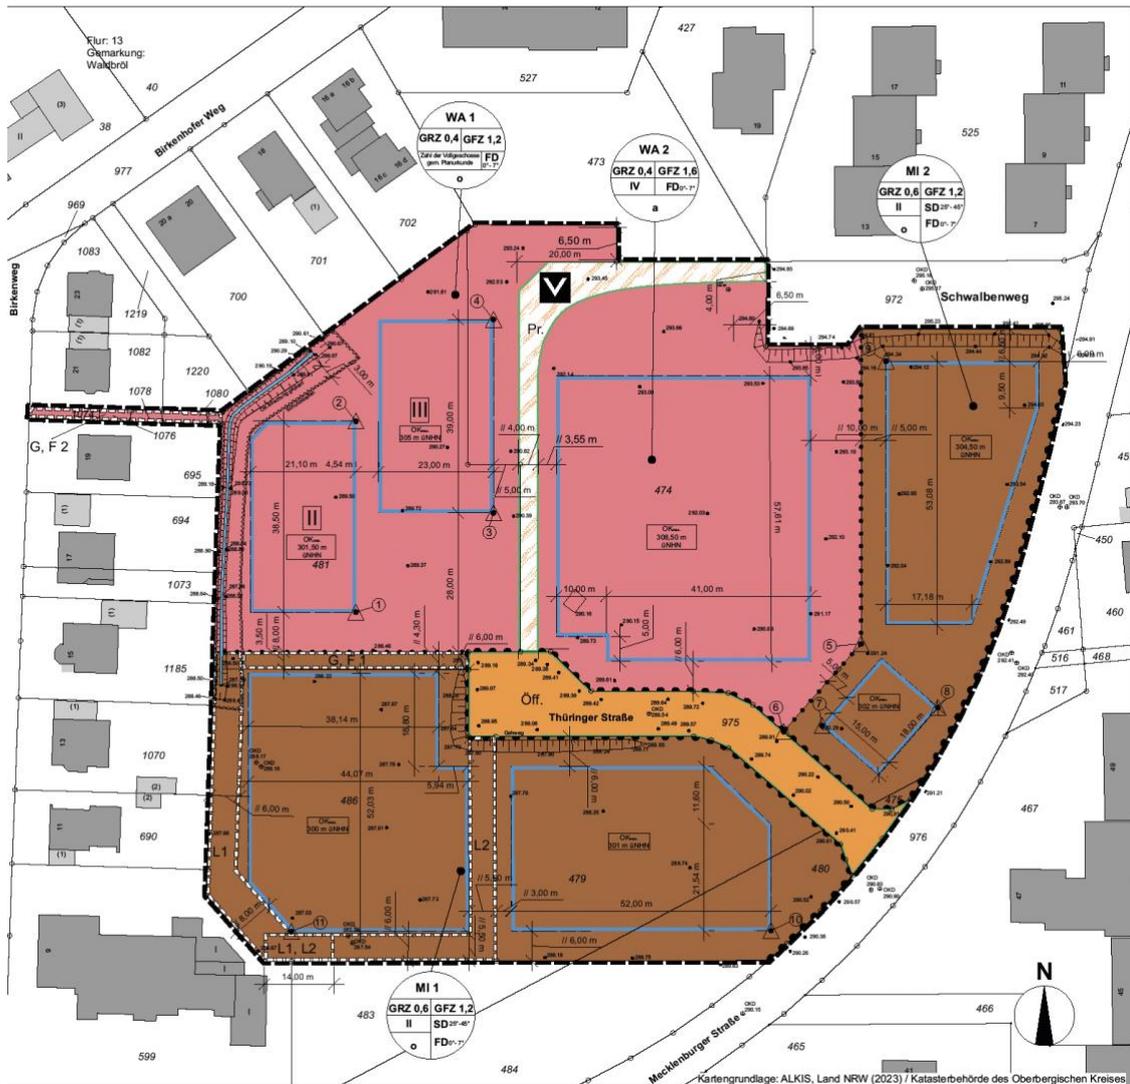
Bebauungsplan (Ausschnitt) im Entwurf (Stand 29.02.2024) (Quelle: Loth Städtebau und Stadtplanung)
